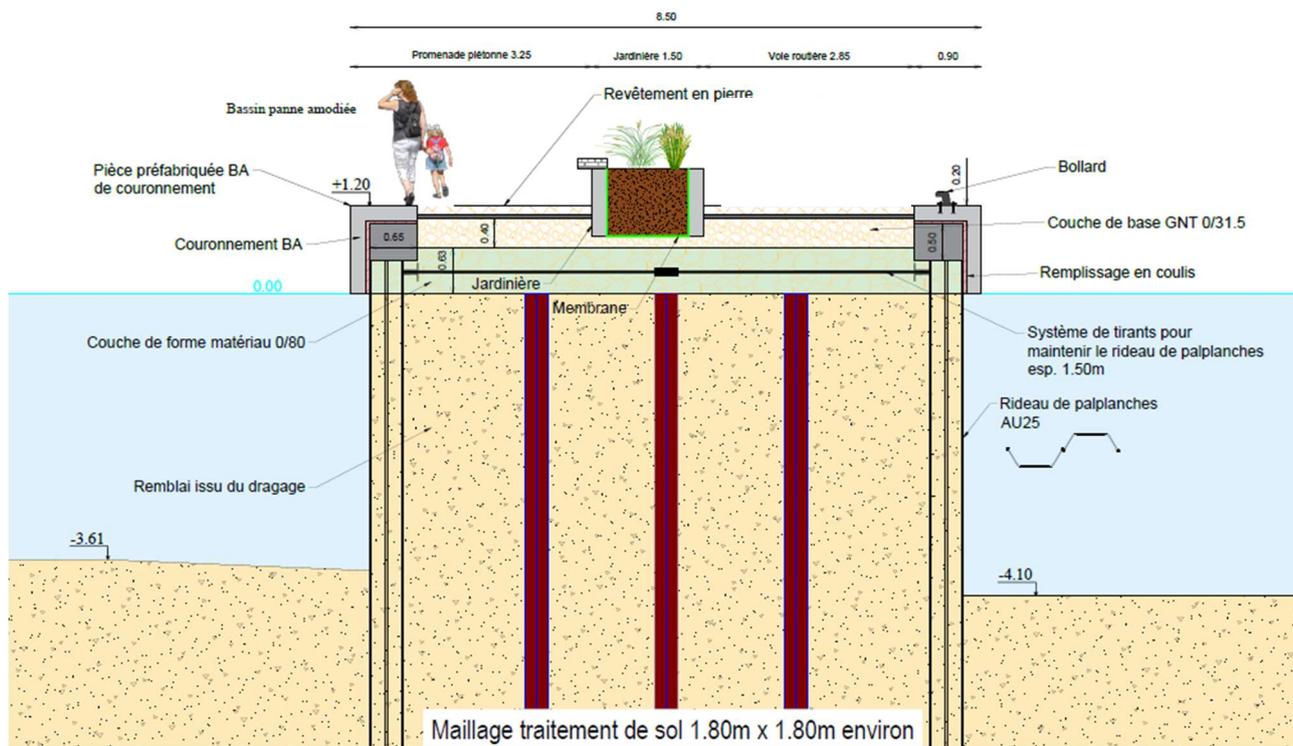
PLAN DU REMPLACEMENT DE LA PANNE AMODIEE COUPE AA DU PONTON Q -EGIS 2023
